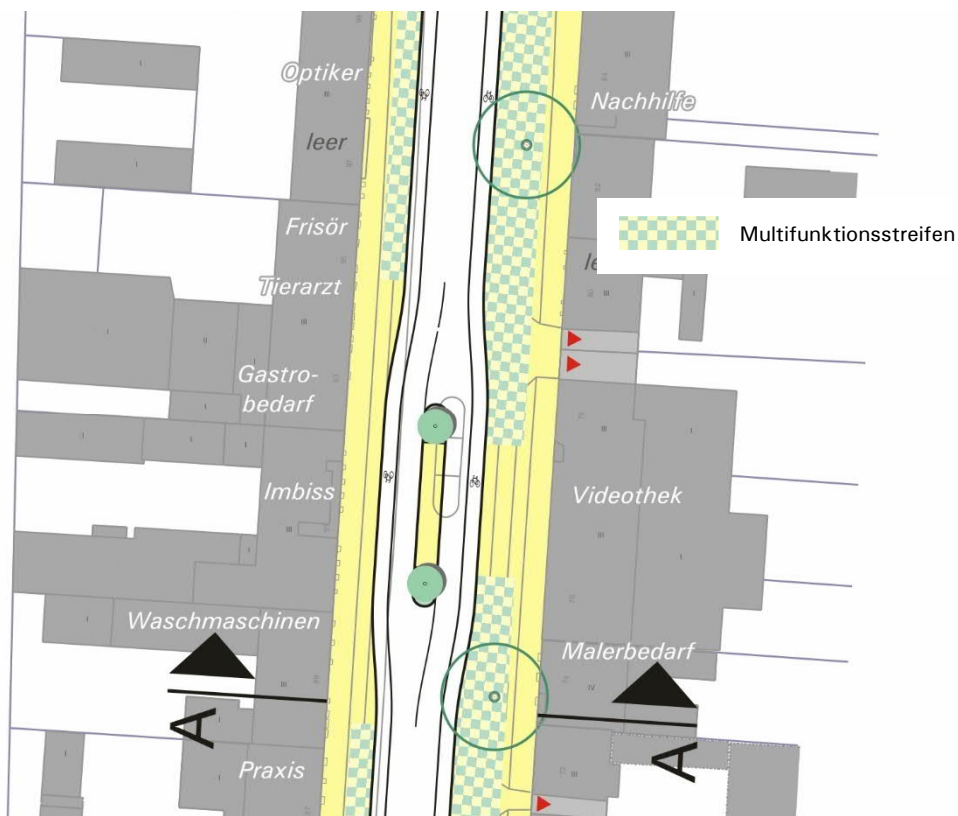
Lageplanausschnitt Urbaner Raum – Variante 1 bestandsoptimiert
